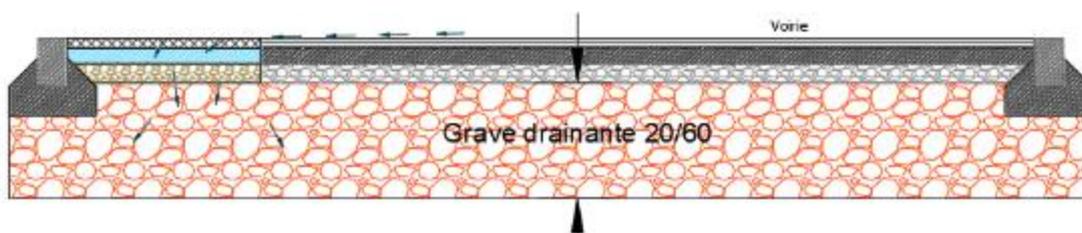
Coupe en travers d'un profil de voirie sur chaussée réservoir et injection par bande poreuse (IS)
